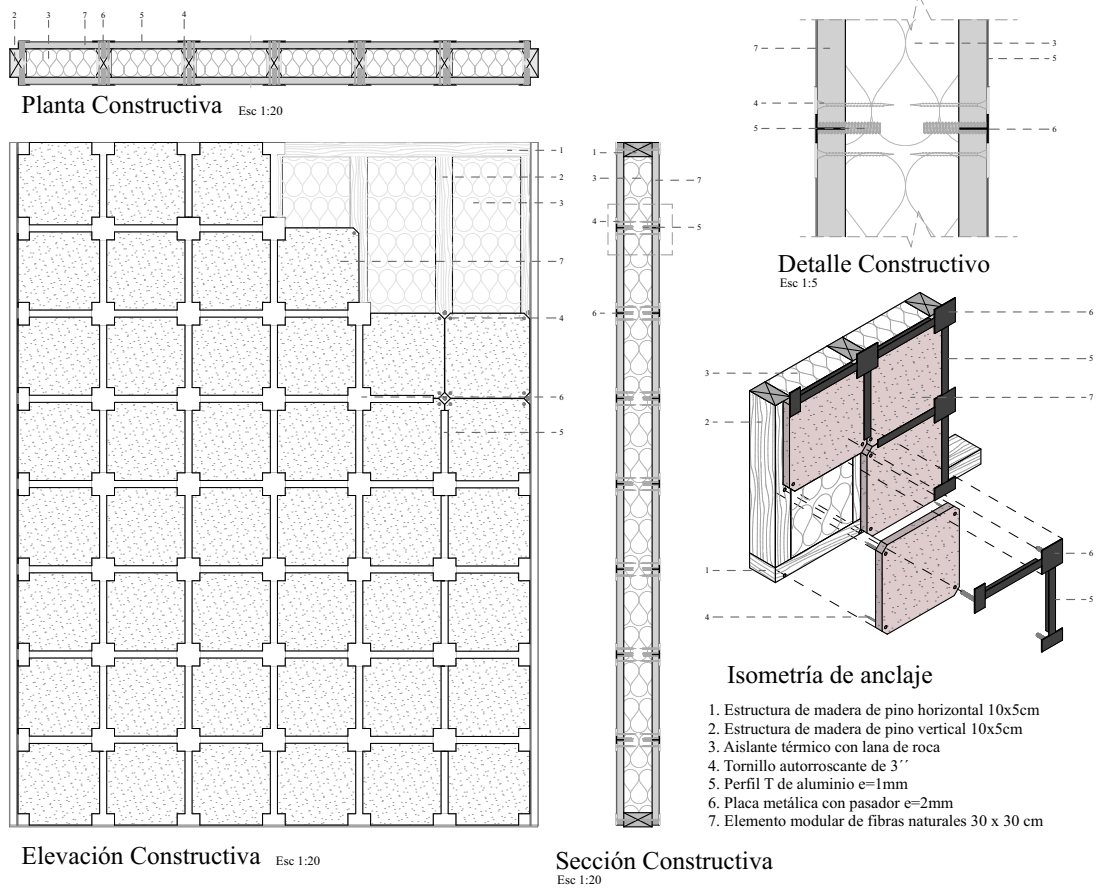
Detalle constructivo para tabiquería liviana diseño 2. Fuente: autor
